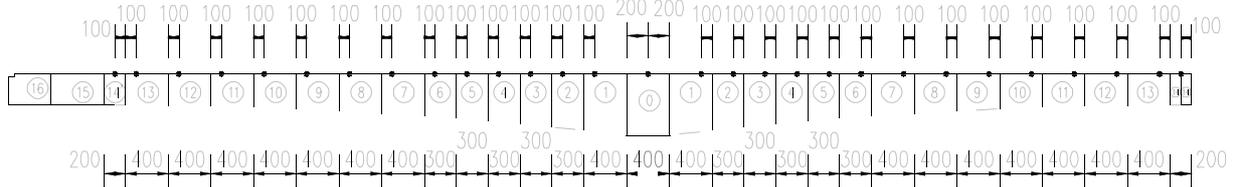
主梁线形测点截面纵向布置图 (单位: cm)
